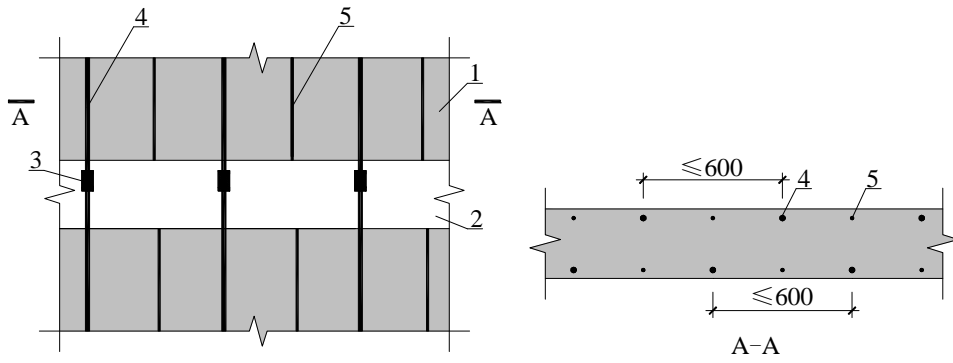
竖向分布钢筋挤压套筒连接“梅花形”部分连接构造示意
